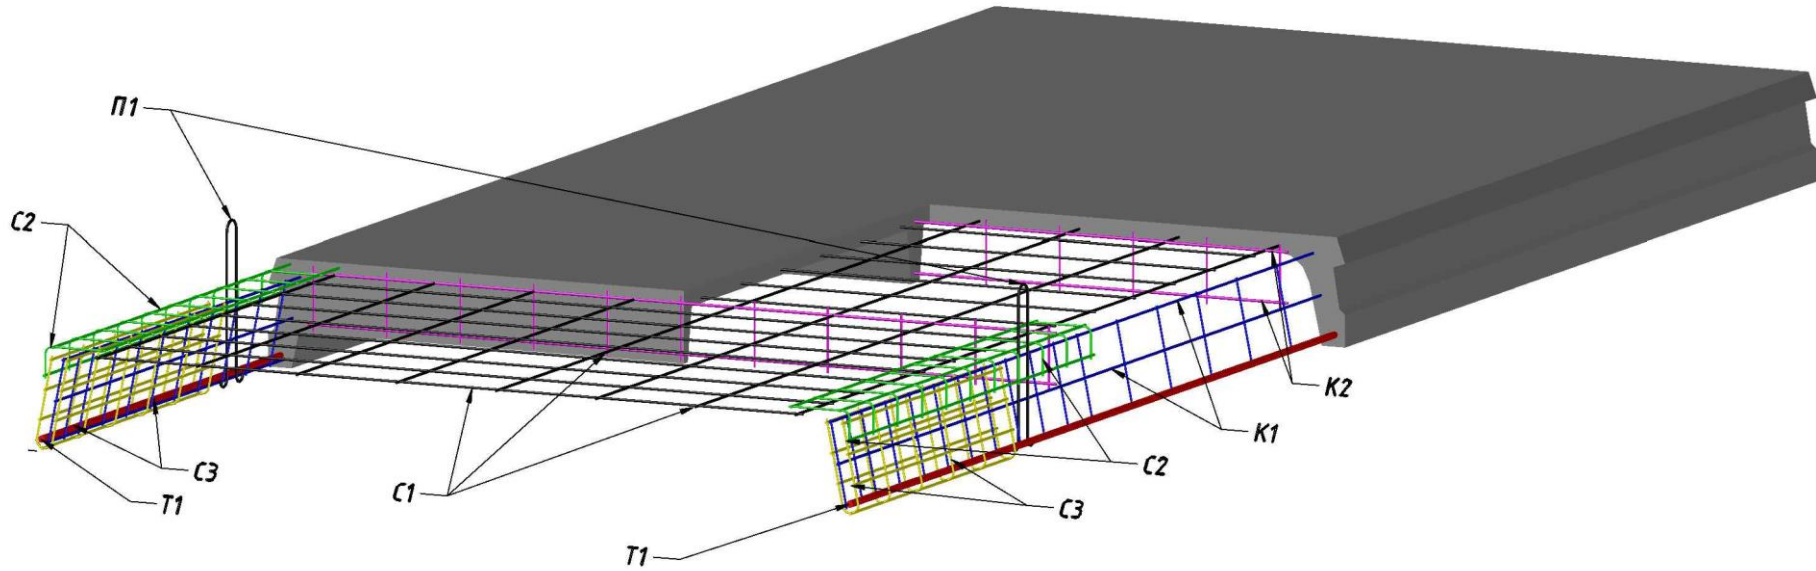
Схема армування ребристої плити (вид А, зверху):
